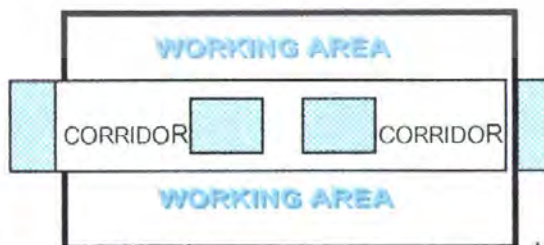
การจัดวาง Working Area แบบ Double Zone Lay - Out ในสำนักงาน ซึ่งมี Shallow Space
